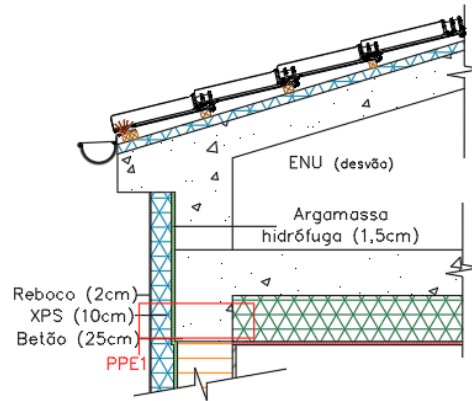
Pormenor construtivo da PPE1 devido à viga
